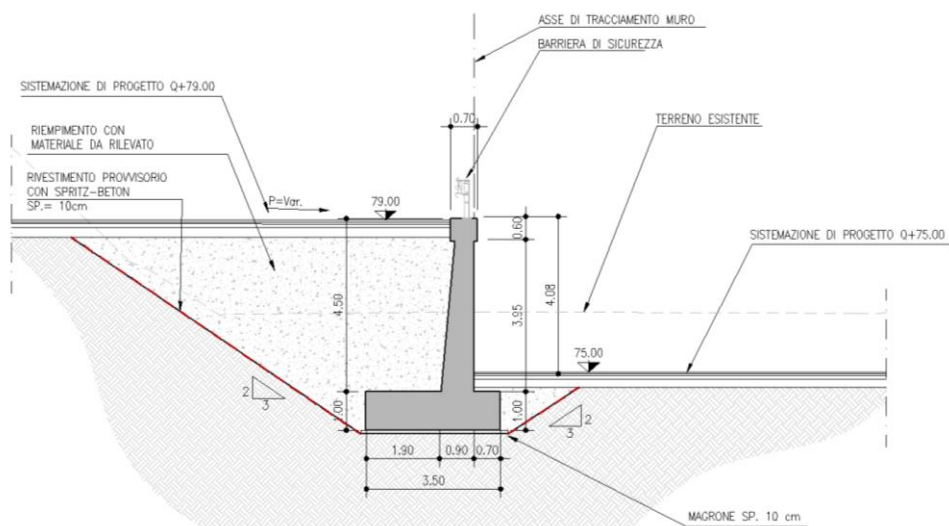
Muro di sostegno MS03 – Sezione tipo 1
